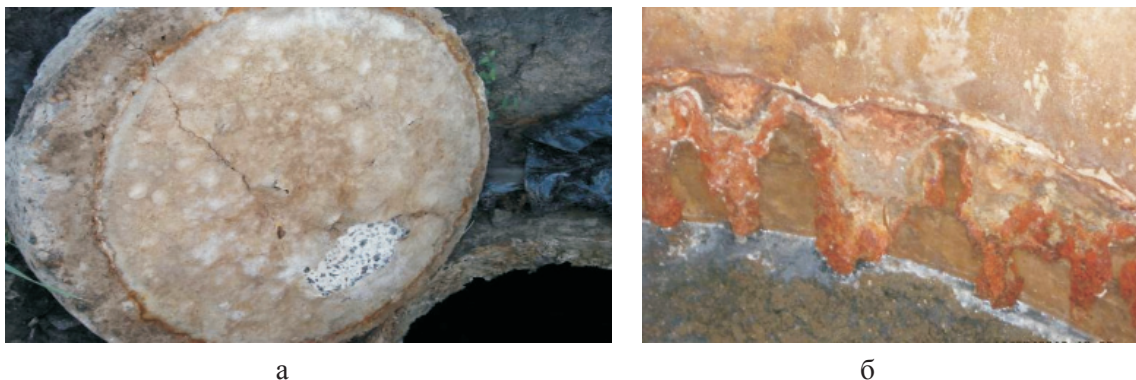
Бетонная крышка септика (а) и корродированная арматура бетона в колодце из железобетонных конструкций (б)
